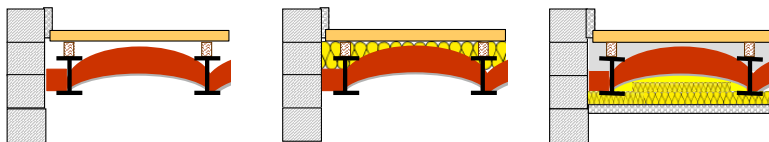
Stahlträger-Kappendecken
